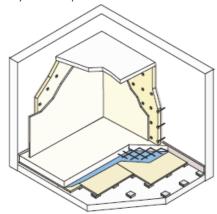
Studios d'enregistrement, discothèques, Salles de machines etc. Des structures et murs intérieurs peuvent être construits sur la dalle flottante pour créer une structure de boîte dans la boîte avec un vide d'air acoustique prévu sur toutes les faces.
